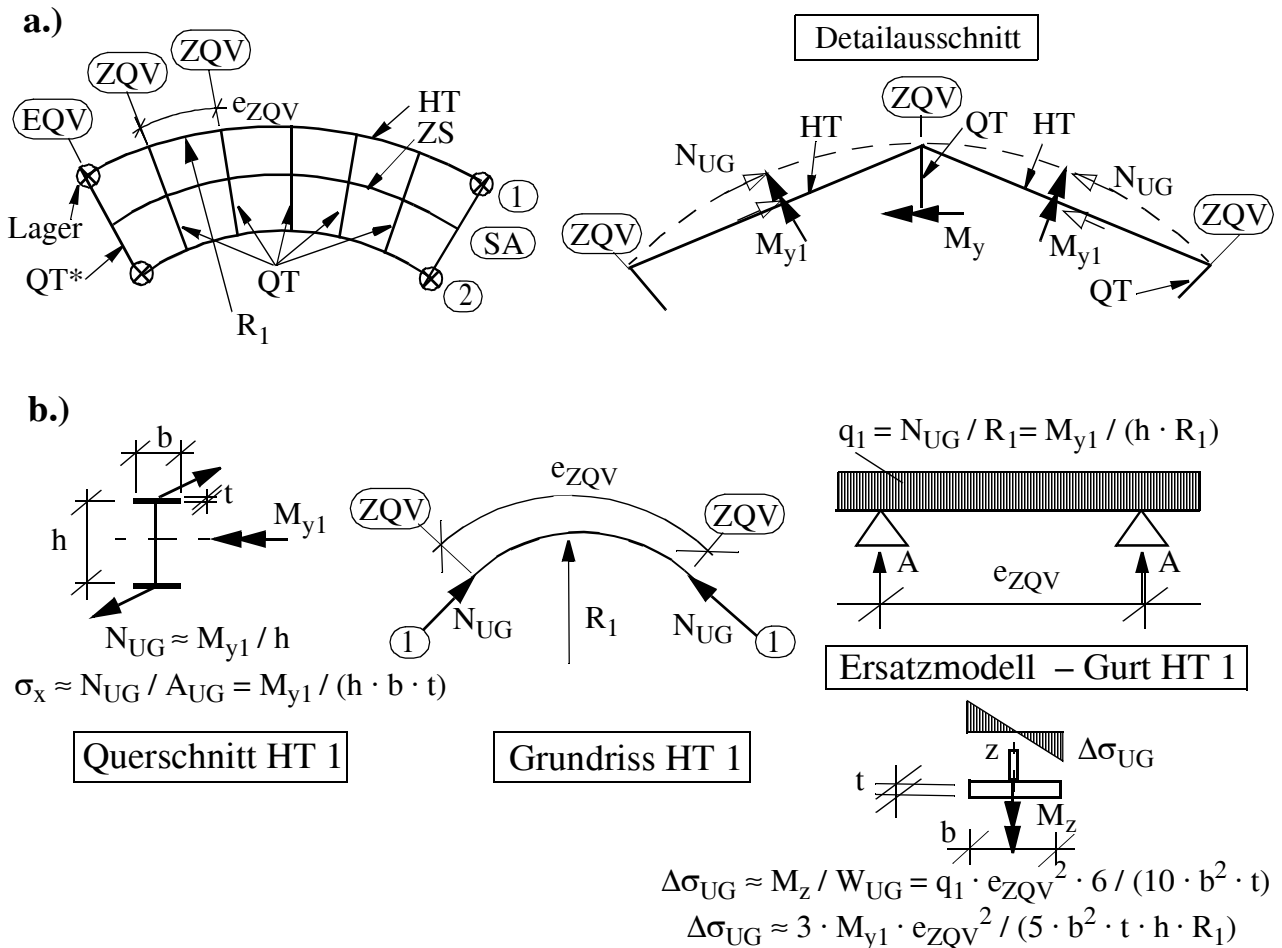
Gekrümmtes Brückentragwerk im Grundriss; a.) Stabmodell im Grundriss, b.) Zusatzbeanspruchung am HT - Untergurt infolge der Hauptträgerkrümmung
